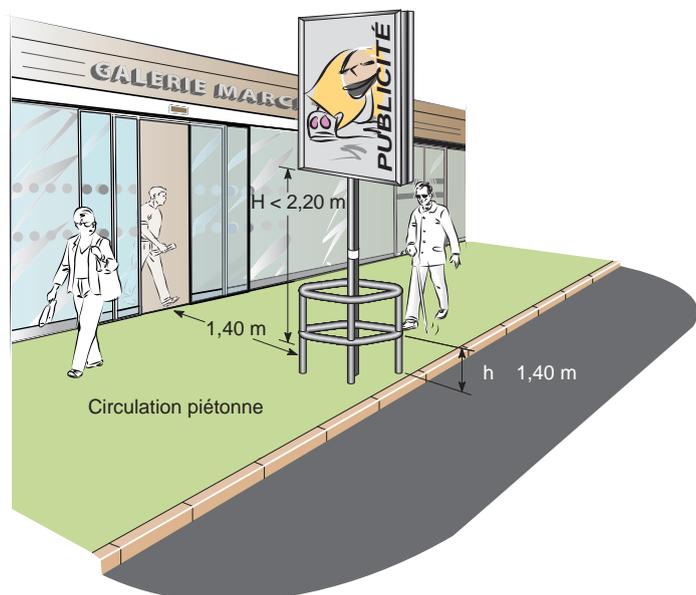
Repérage du porte à faux d'un poteau par des barrières de protection.
